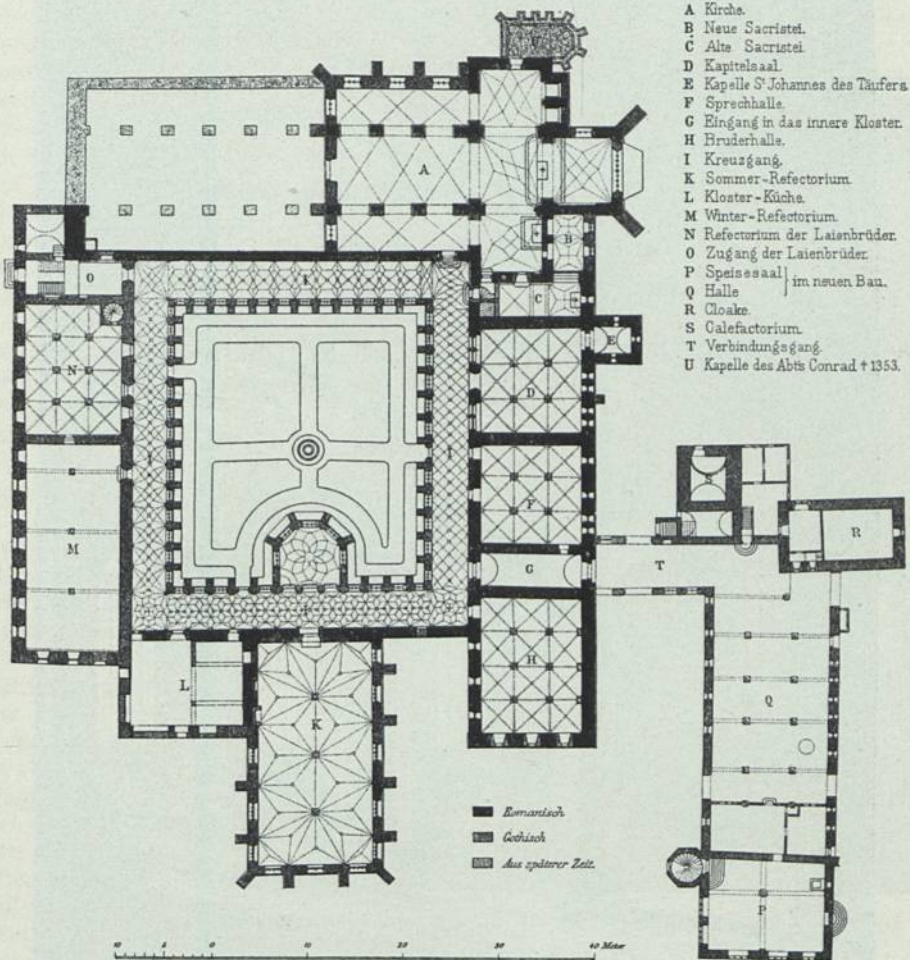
Grundriss des Klosters Bebenhausen
